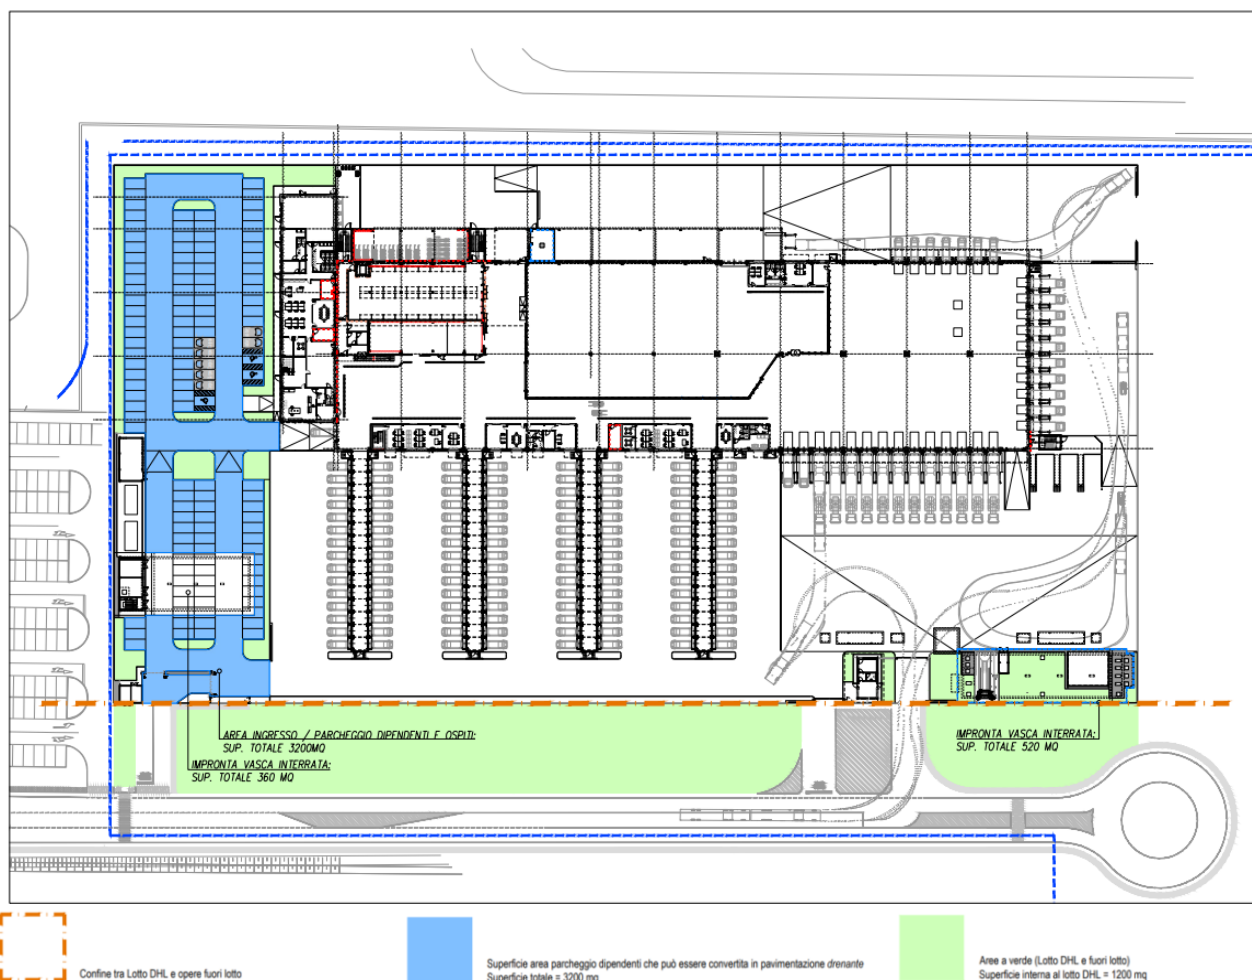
PLANIMETRIA GENERALE – MAPPATURA PAVIMENTAZIONI DRENANTI (elab.CO_G_02_210_001_00)
